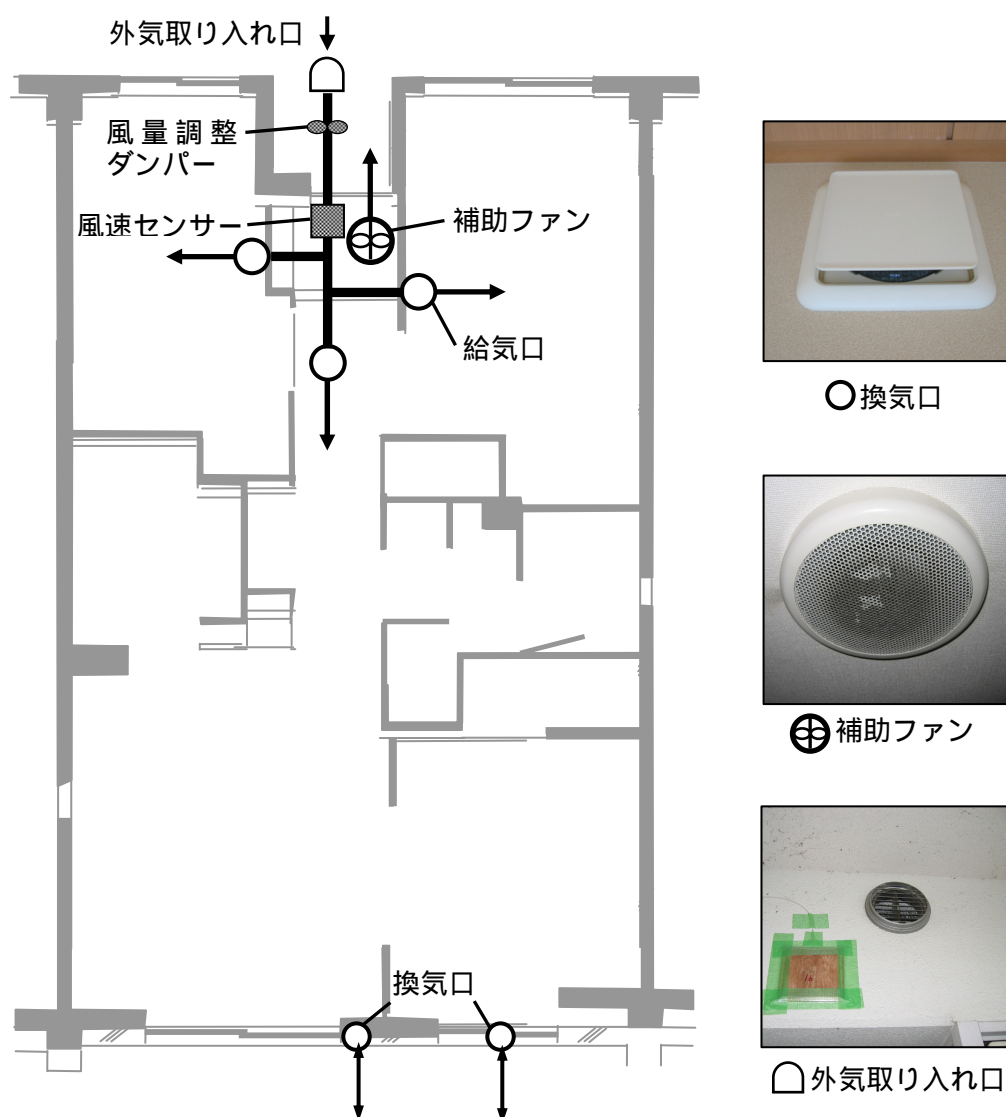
実測対象住宅の平面図及び換気設備の概要図
